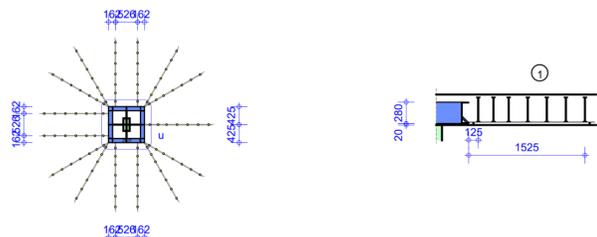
Durchstanzbewehrung Einstellhallenstützen
